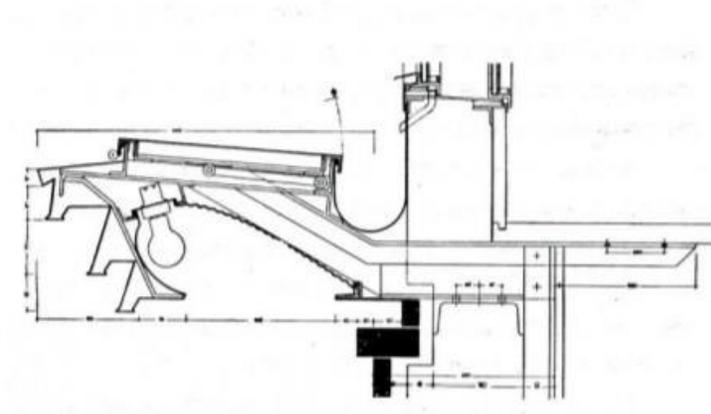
Detalle de instalación de la propuesta de iluminación. Erich Mendelsohn, 1924
